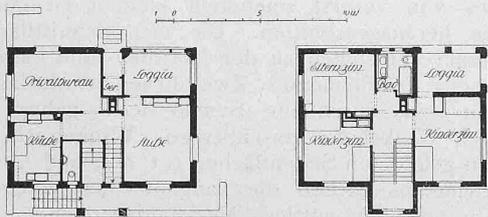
und 5. Grundrisse vom Erdgeschoss und Obergeschoss 1 : 400 des Einfamilienhauses Luisoni in Schlieren. Architekt J. B. Frisch in Zürich.
